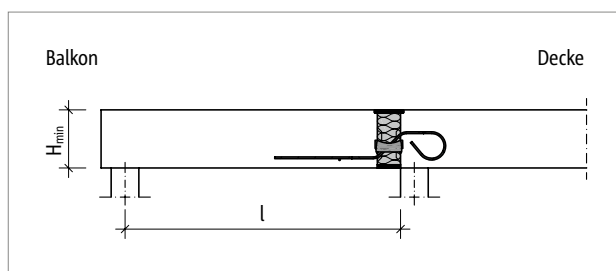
Schöck Isokorb® T Typ QL-V1: Statisches System
